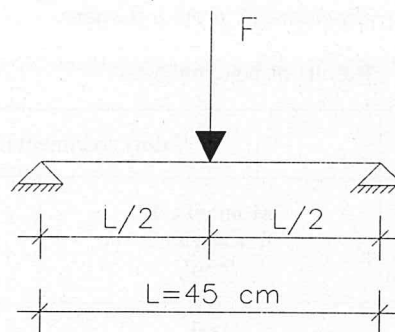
Schema statico delle prove a flessione sui pali di tipo B3 e A4.
